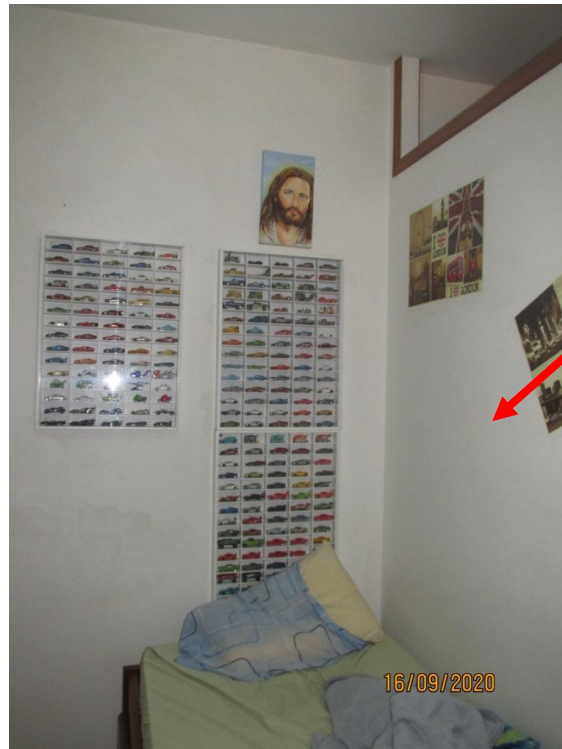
Vista do "2º quarto", criado pela divisória com drywall
